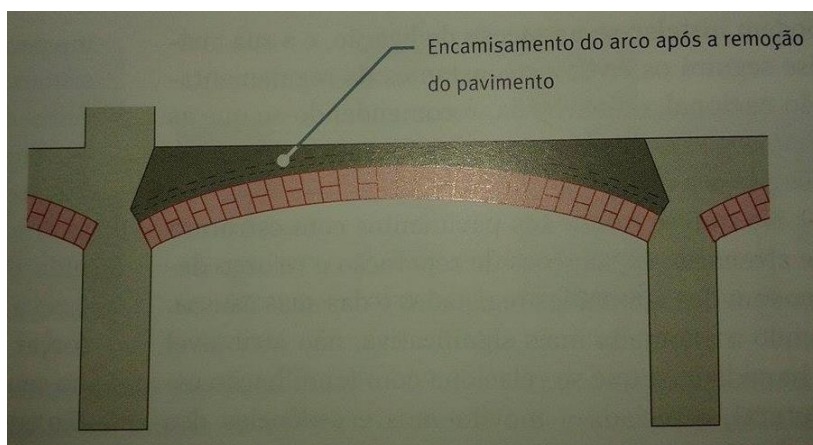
Representação esquemática do encamisamento de pavimento com estrutura de abóbada (Appleton,2011)
